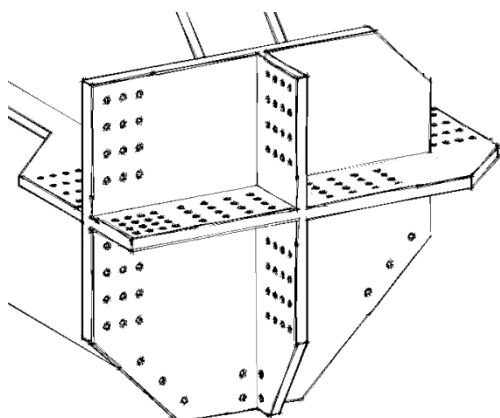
Elementi in acciaio per assemblaggio mediante collegamenti bullonati (stabilimento Cimolai – Pordenone)
